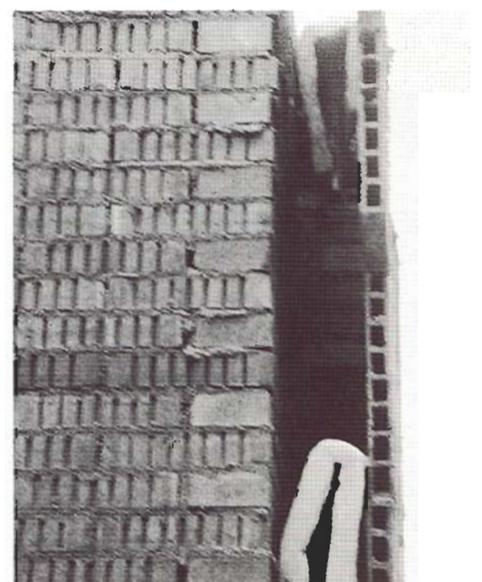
Graves errores en la colocación de láminas aislantes en las primeras cámaras de aire.
